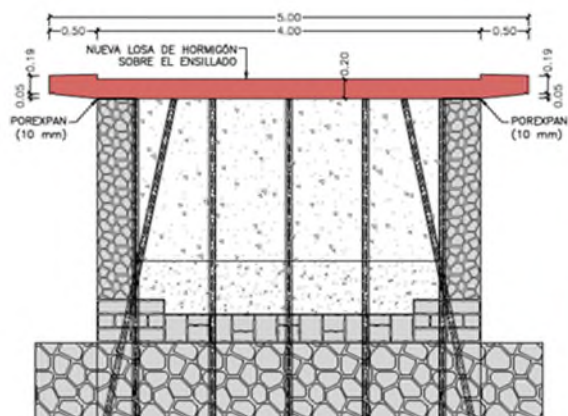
Ejecución de losa de hormigón armado para plataforma.
